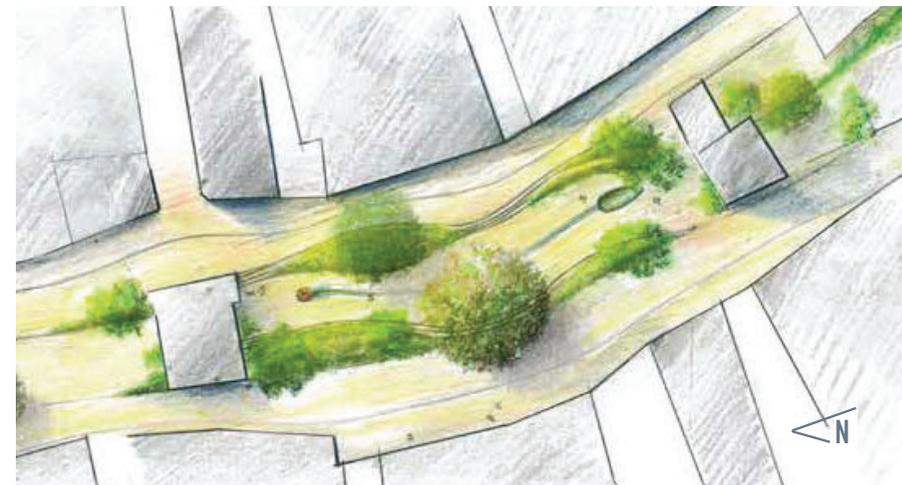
Variante 2 - Grundriss Ausschnitt
